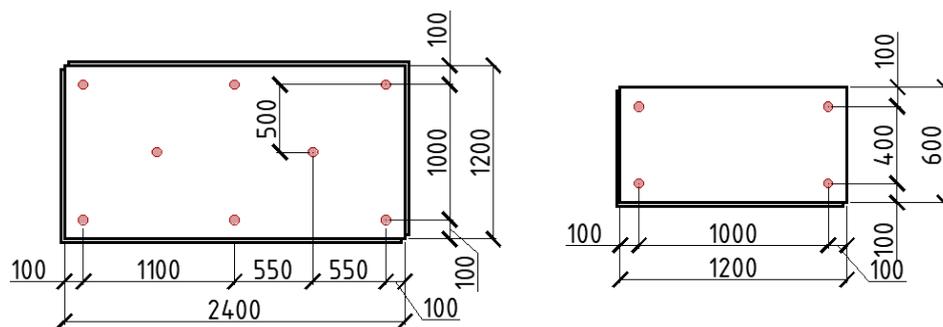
Схема крепления теплоизоляционных плит из PIR
